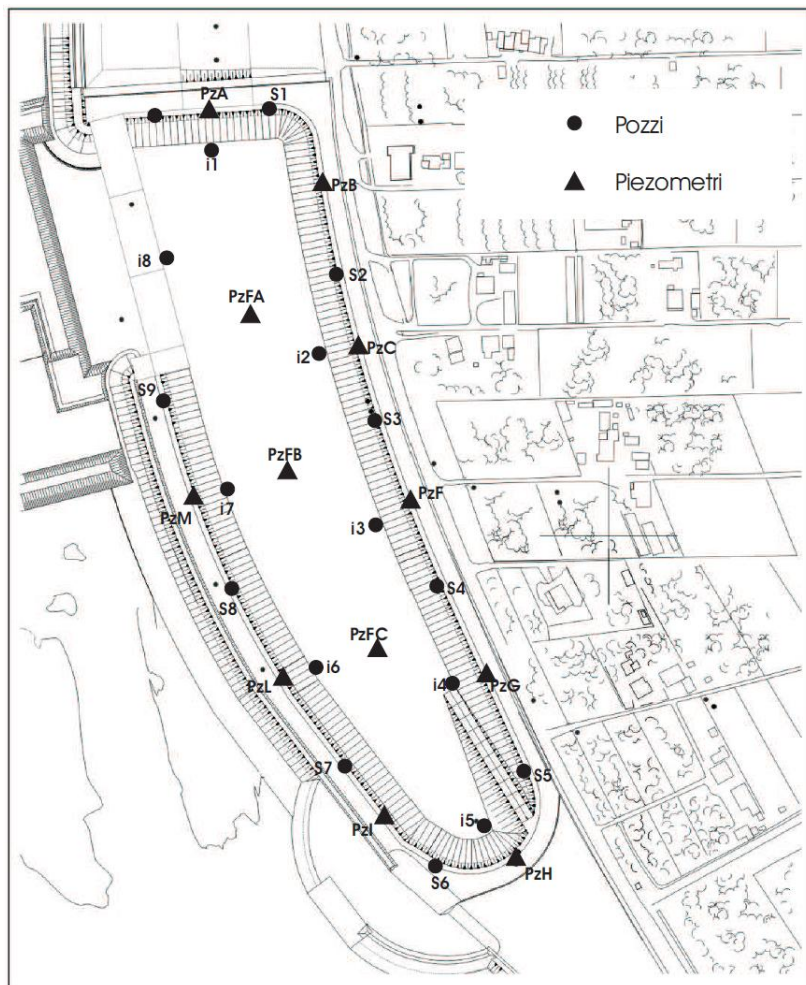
Planimetria del sistema di dewatering della tura (fonte: Consorzio Venezia Nuova).
